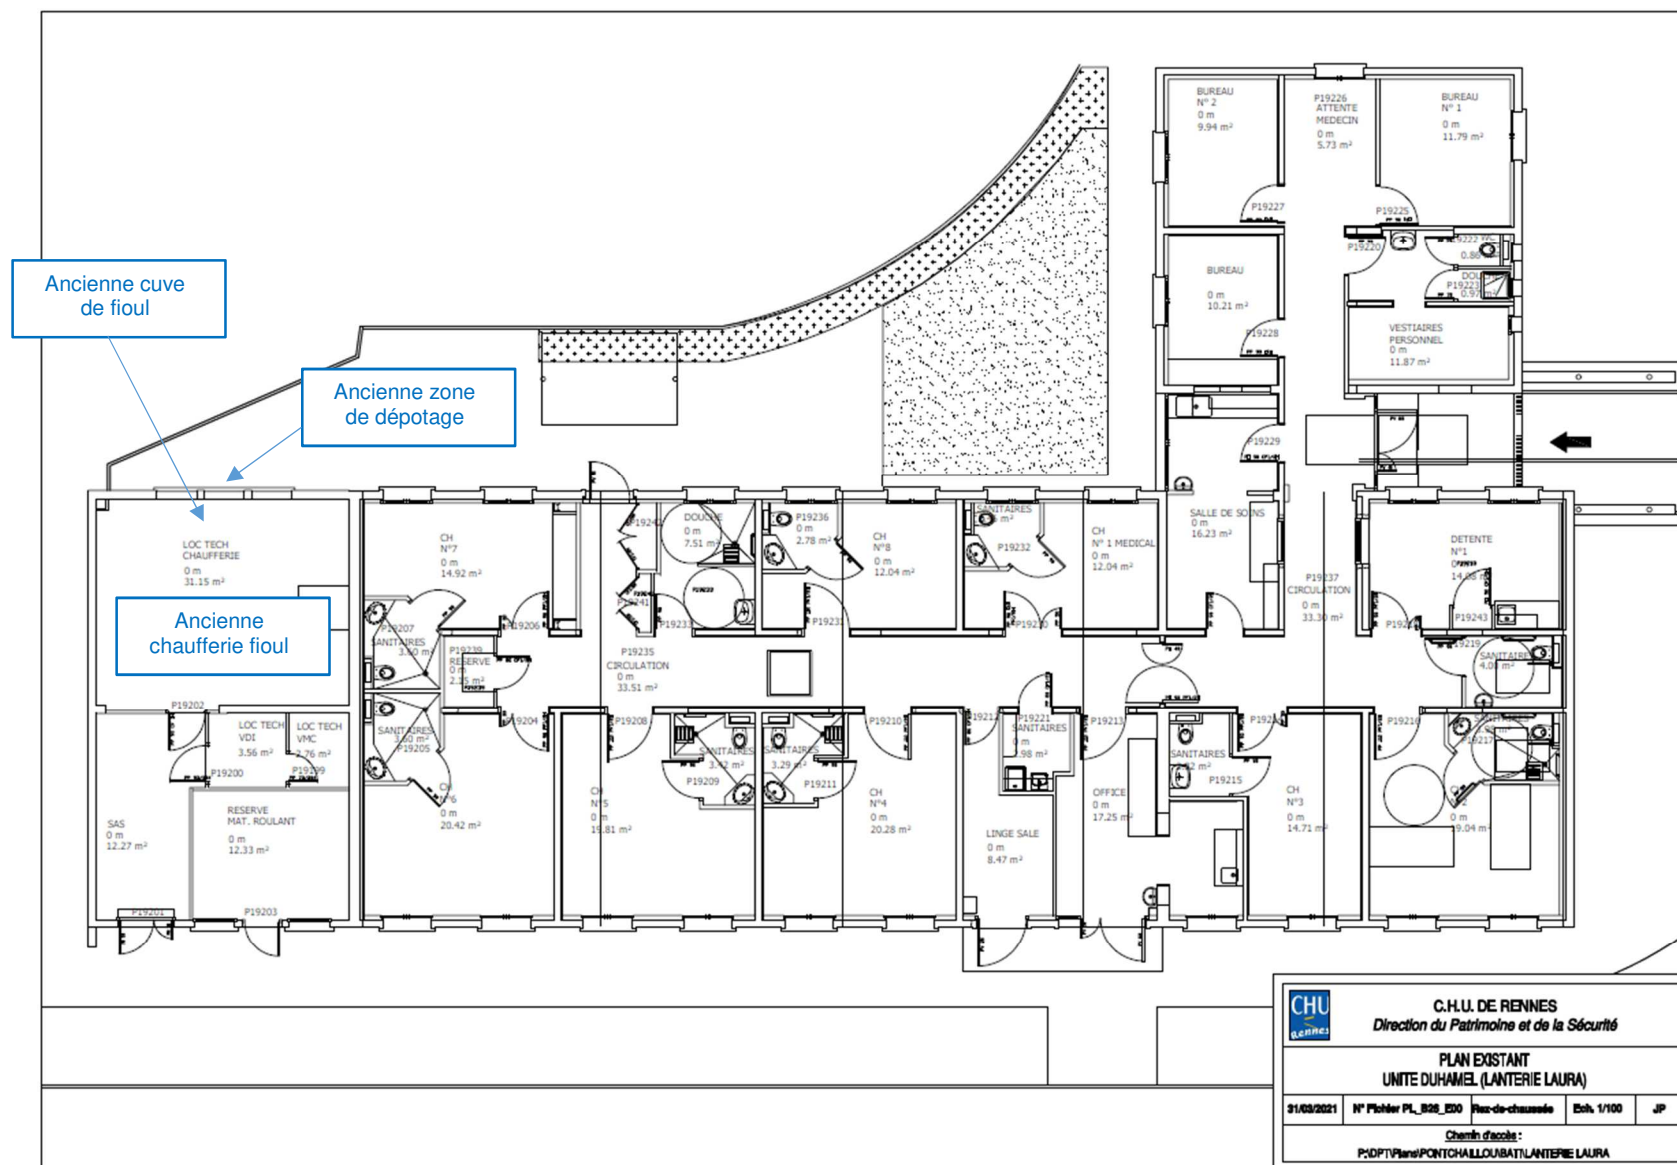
Plan de masse – Lantéri-Laura (Rez-de-chaussée) (Source : CHU Pontchaillou)
